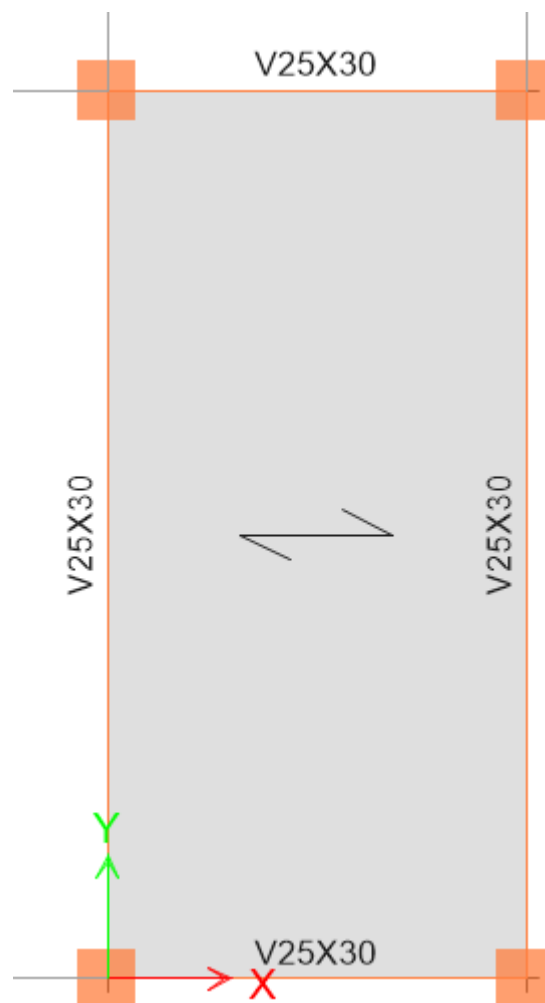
Planta estructural de vigas aéreas– Identificación de elementos.
